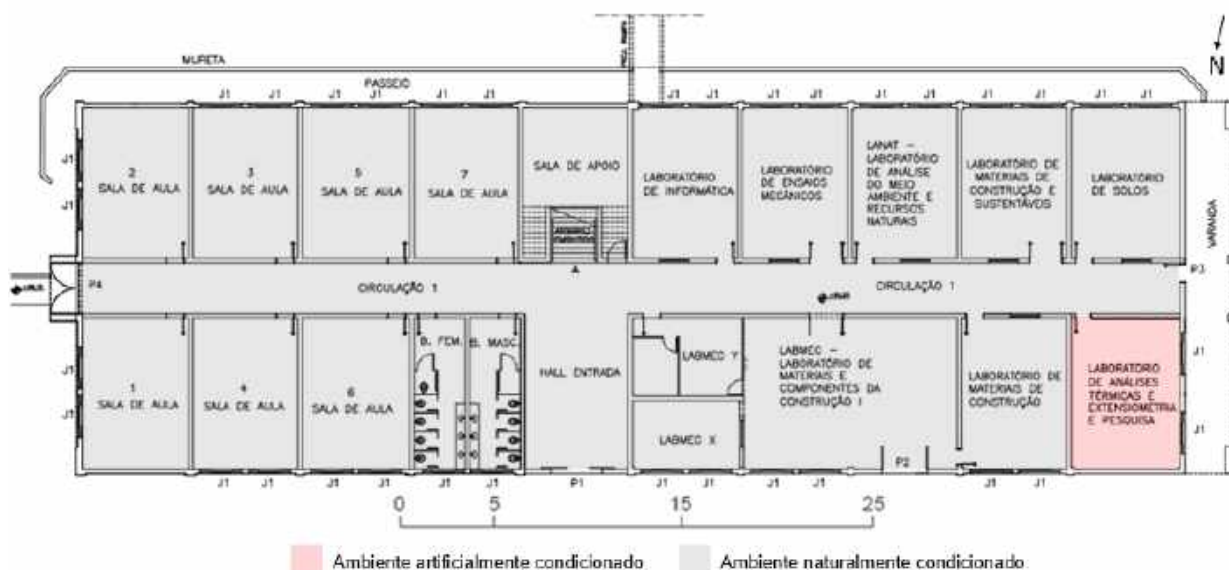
Planta baixa do Prédio 12 – 1º Pavimento
